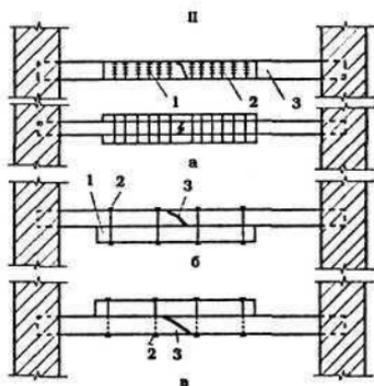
Ремонт деревянных перекрытий (продолжение):
